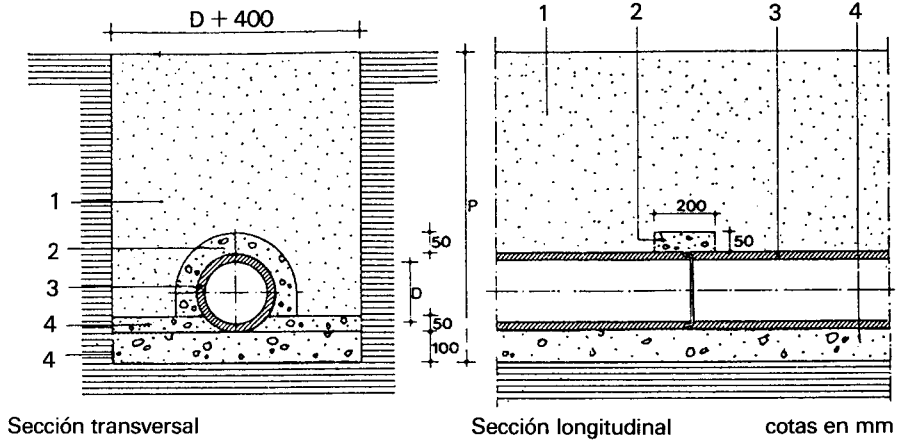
Colector enterrado de hormigón. 1. Relleno de la zanja con tierra exenta de áridos mayores de 8 cm y apisonada. 2. Corchete de hormigón. 3. Conducto de hormigón. 4. Solera y recalde de hormigón.
